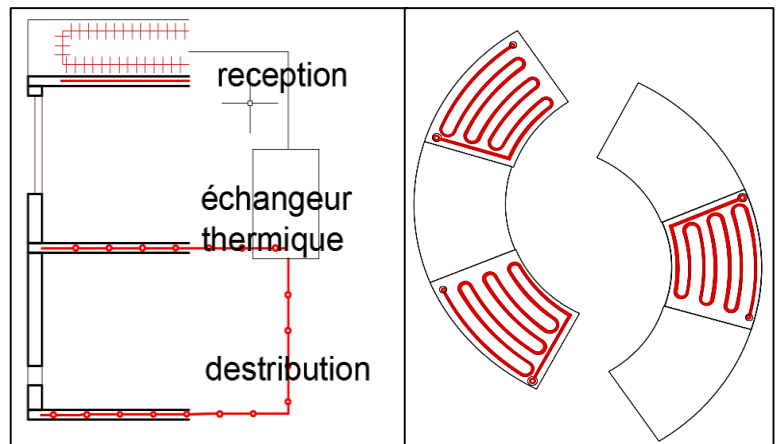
coupe de et plan fonctionnement des panneaux solaires thermiques
